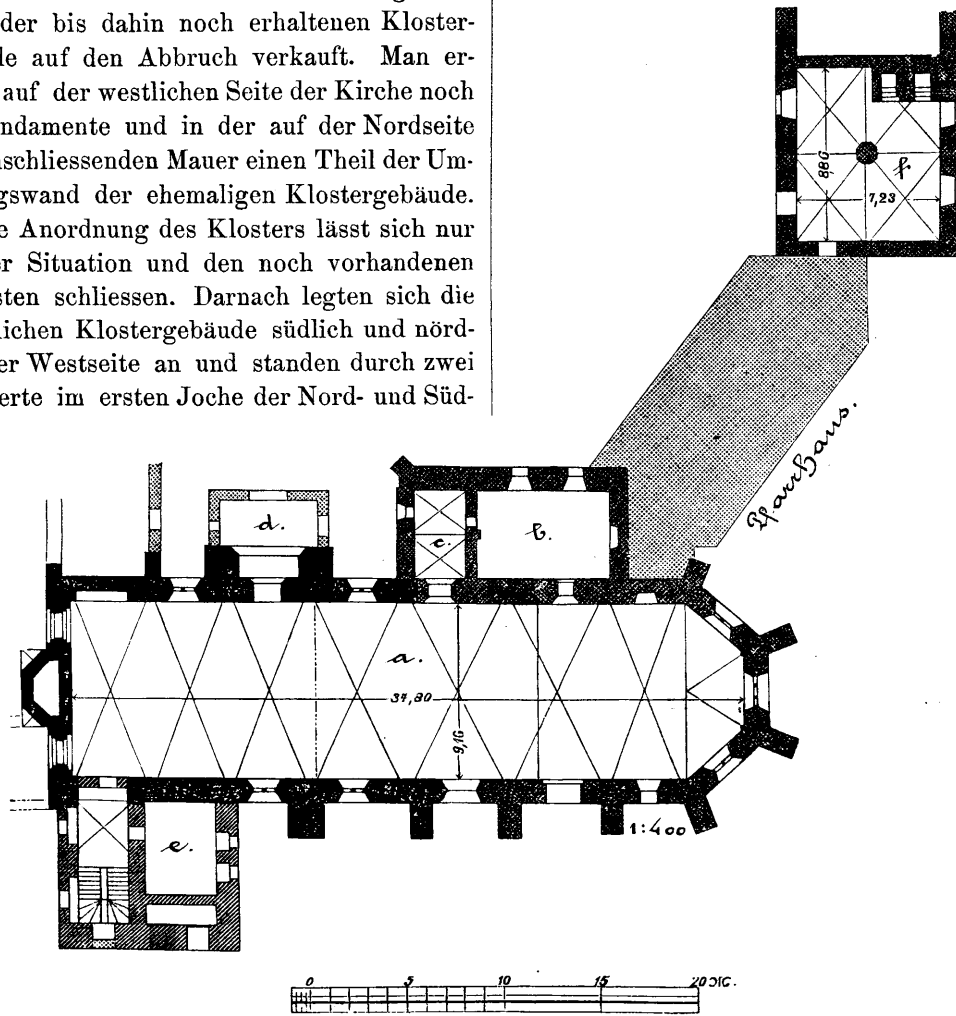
Zuckau. Grundriss der Klosterkirche.
